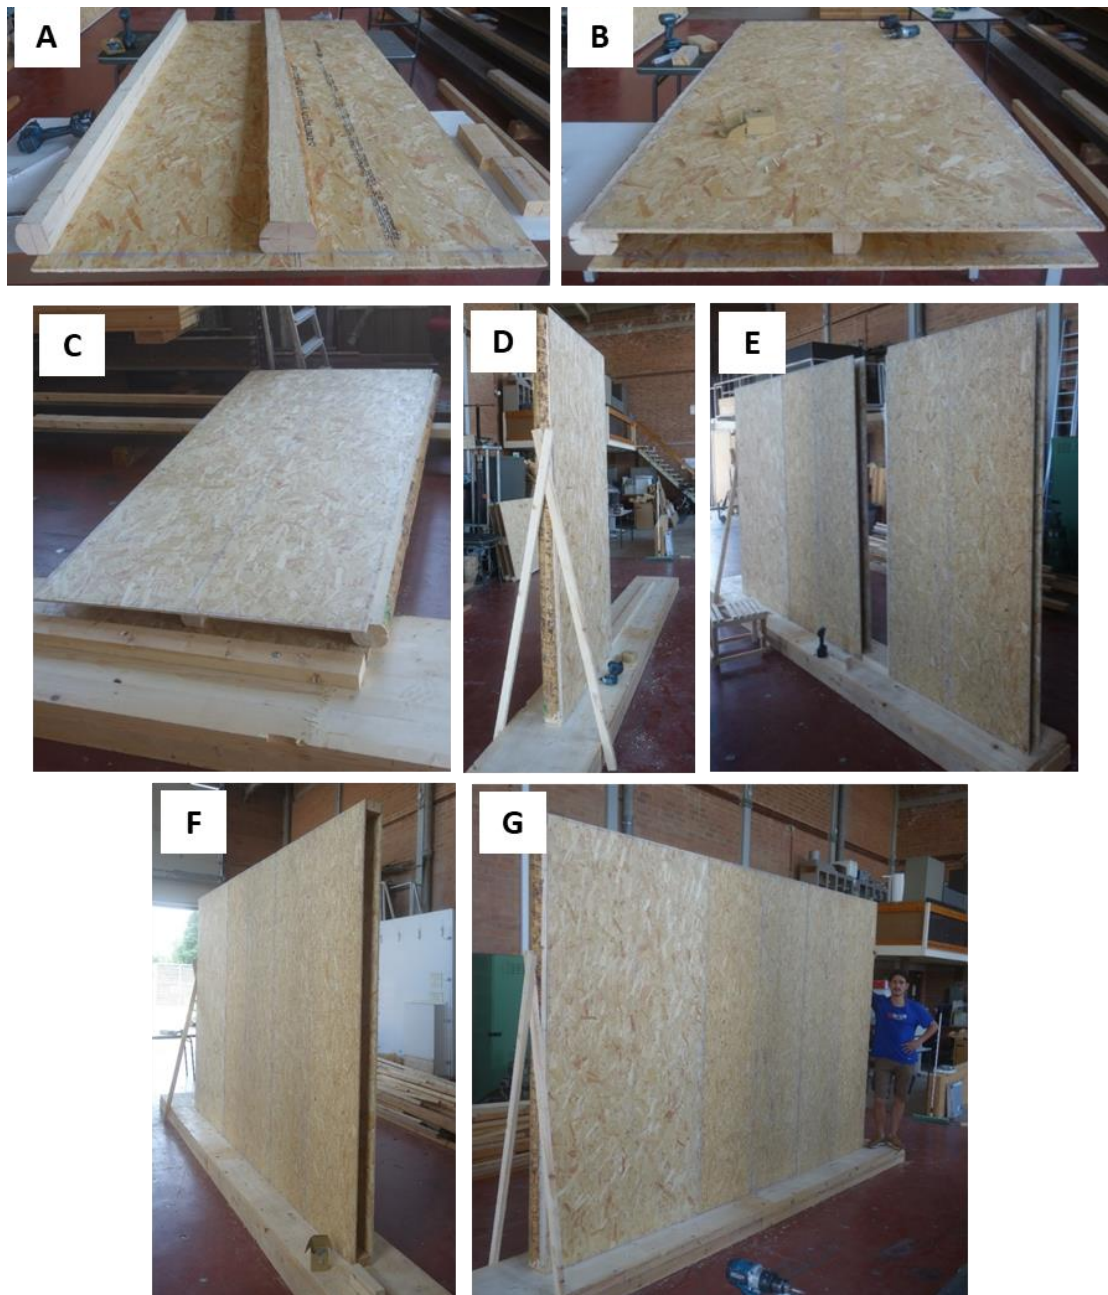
Photos du démonstrateur. A : Fixation des montants au panneau avec une entraxe de 60 cm. B : Fixation du deuxième panneau de contreventement. C : Pose d'un panneau structurel (kit final) sur la lisse basse. D : Fixation du panneau structurel à la lisse basse après avoir été mis à niveau. E : Emboîtement du troisième module au panneau précédent. F : Fixation du troisième module et de la lisse haute. G : Vue d'ensemble du démonstrateur terminé.
